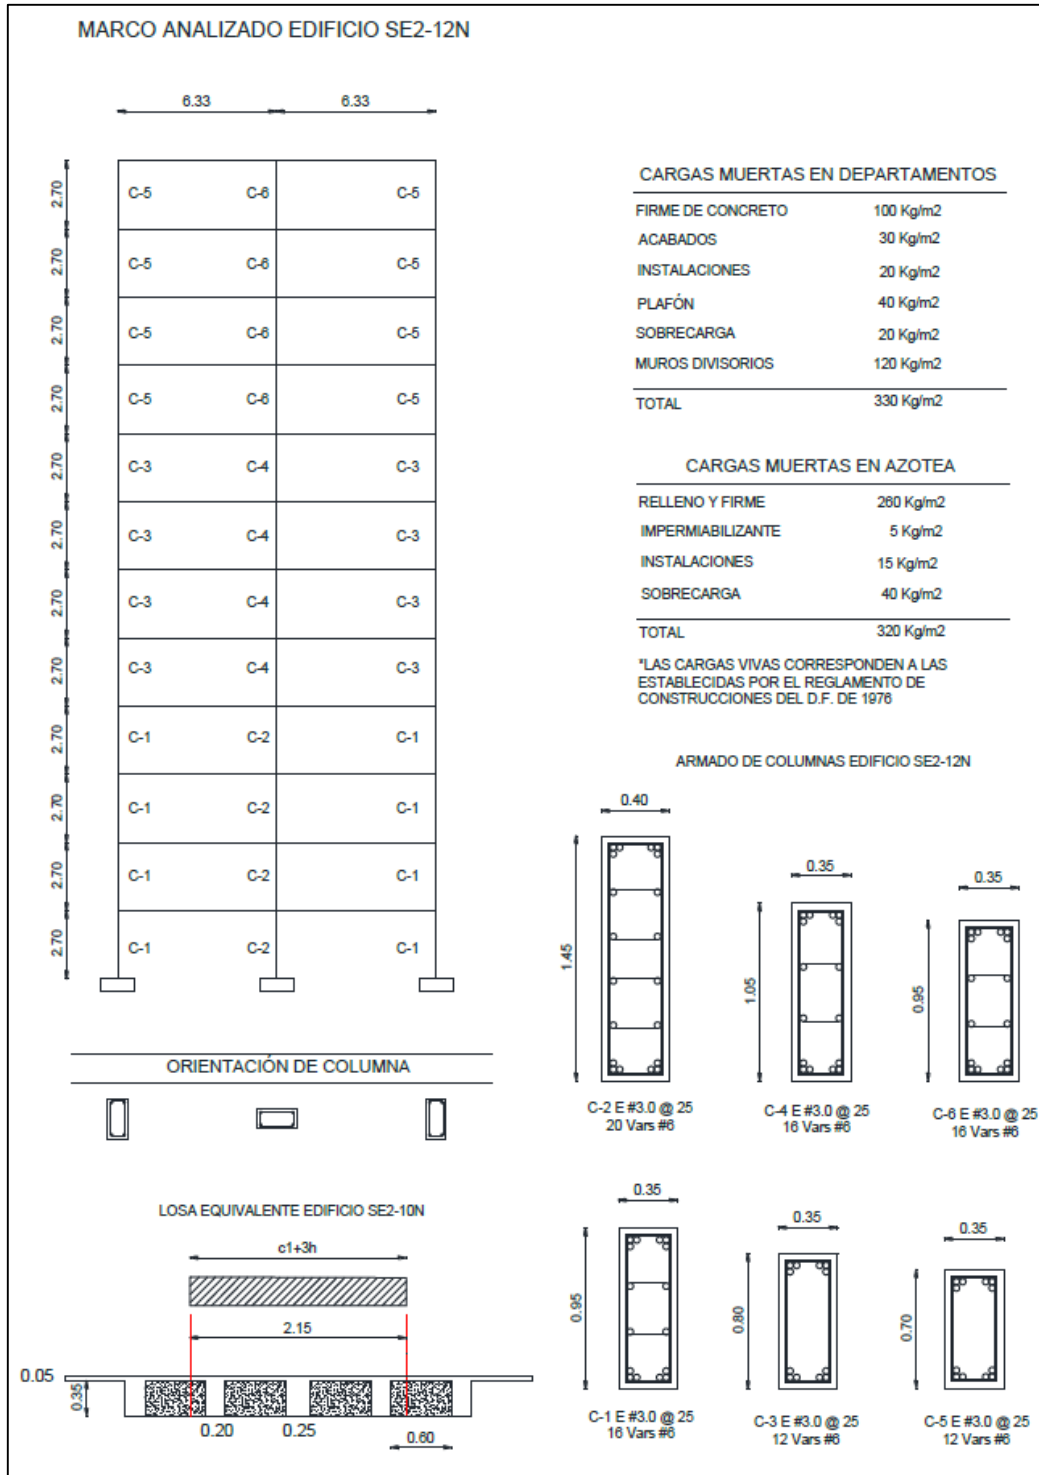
Detalles estructurales y cargas del edificio SE2-12N usadas en el análisis no-lineal.
